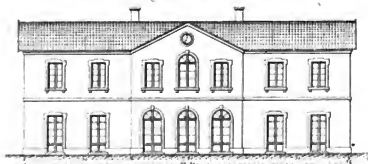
Elevation latérale à 0 005 p 1^{re}
